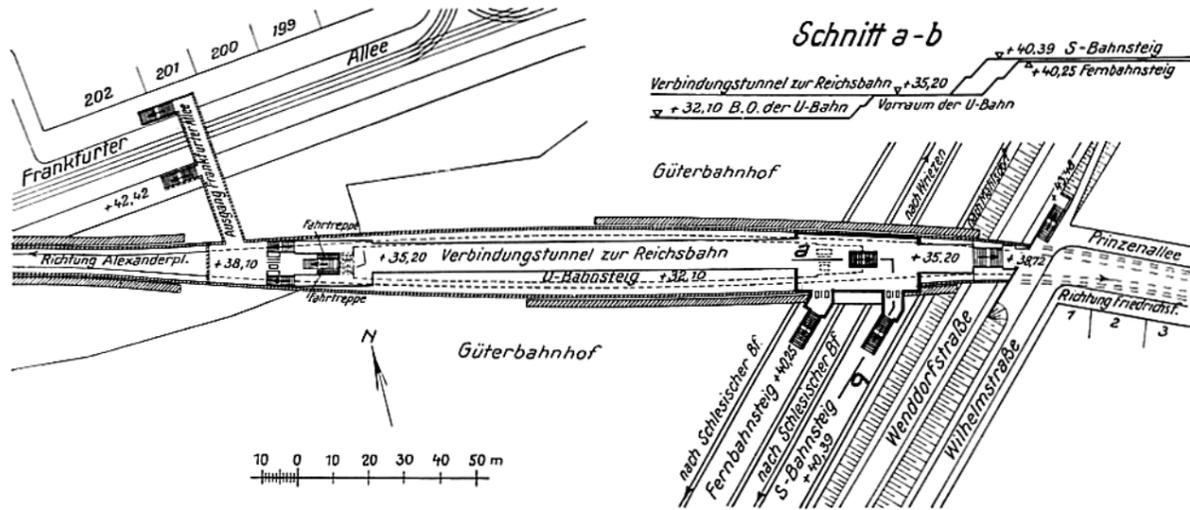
Bahnhof Lichtenberg, Lageplan.
